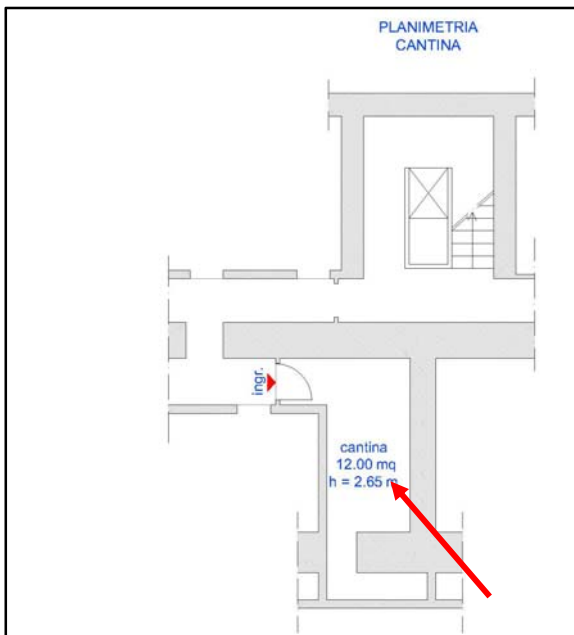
Plan. stato dei luoghi cantina del 11/12/2020
